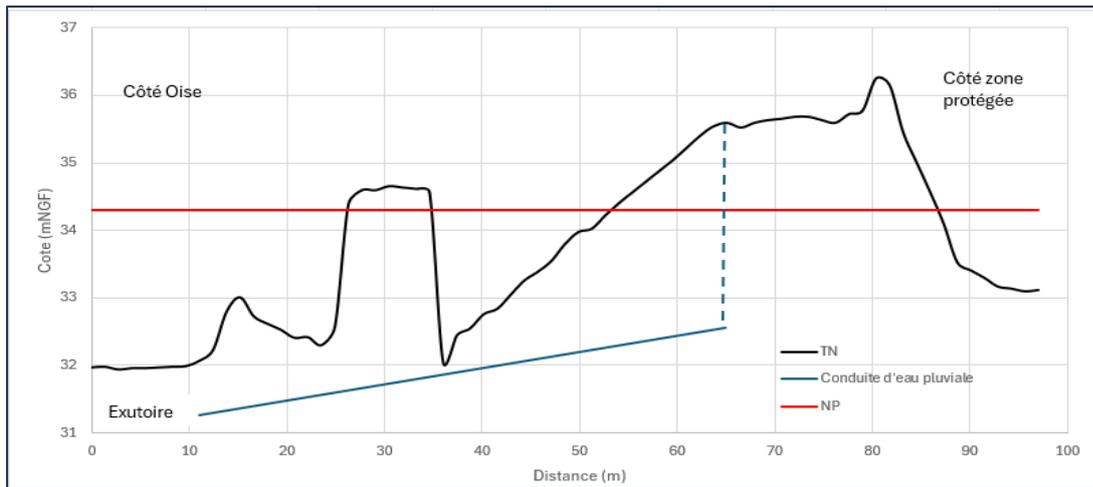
Profils en travers de la RD932 et l'emplacement de la canalisation traversante
